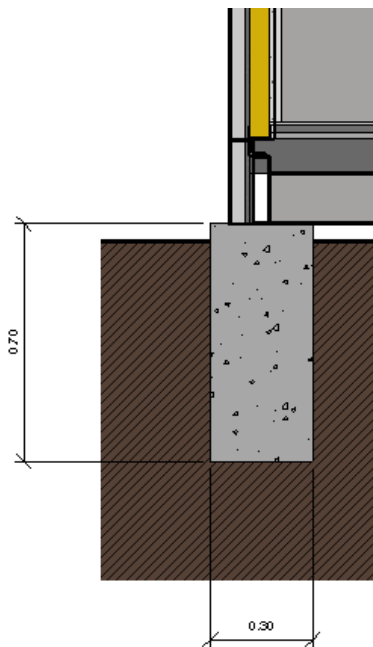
Detalle Apoyo Sobre Cimento Aislado.
